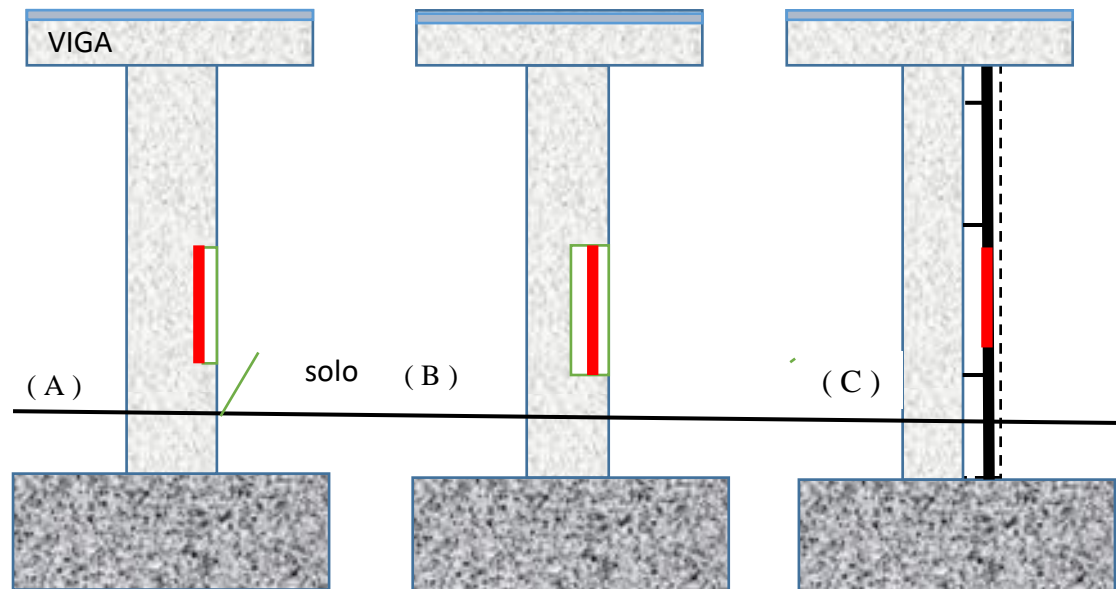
Opções de corte de concreto em reparações estruturais
